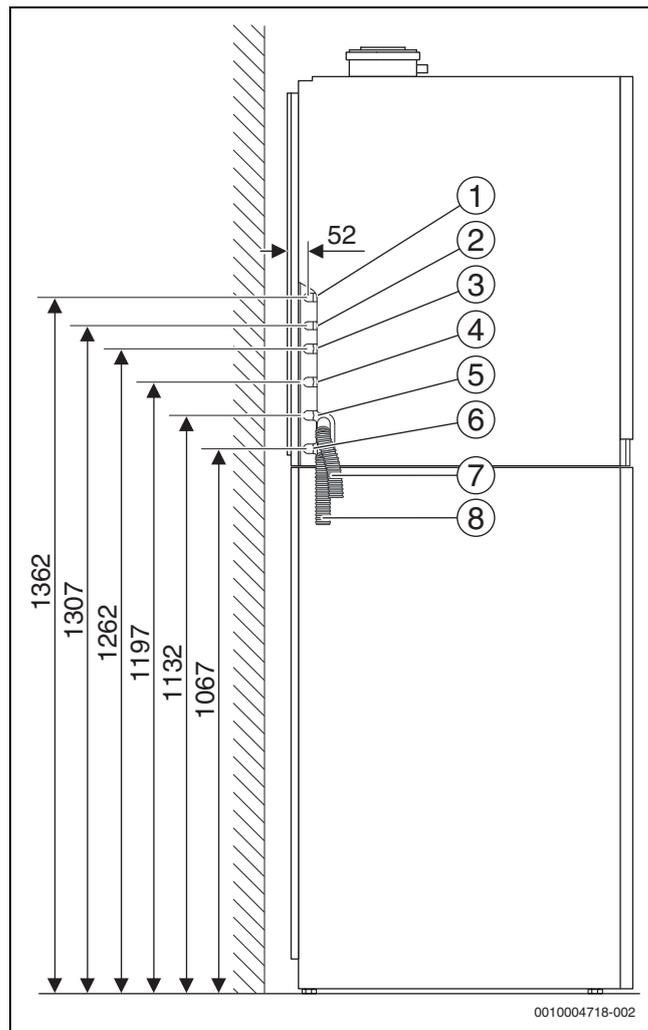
Misure di collegamento dell'accessorio AS-H1/Set di collegamento orizzontale (misure in mm)
